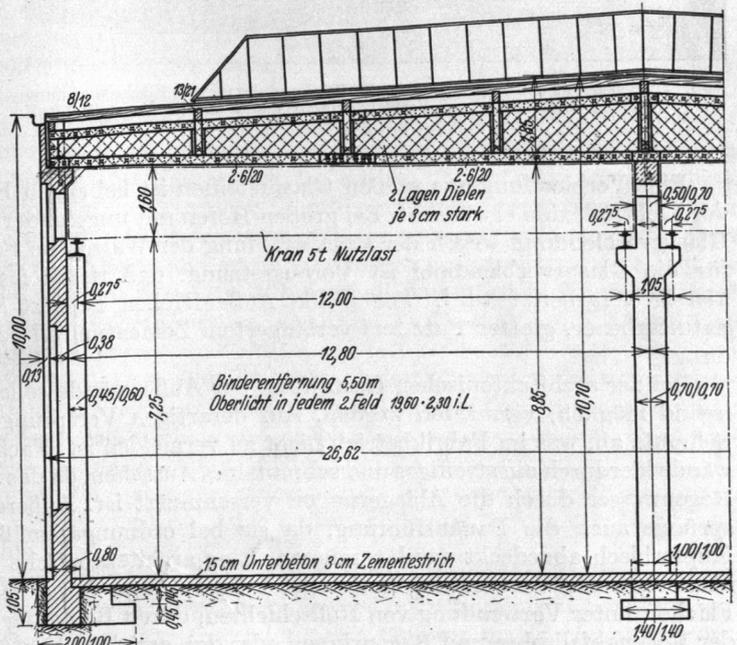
Werkstatthalle in kombinierter Bauweise: Umfassungswände in Mauerwerk, Stützen in Eisenbeton, Binder in Vollwand-Holzkonstruktion.
